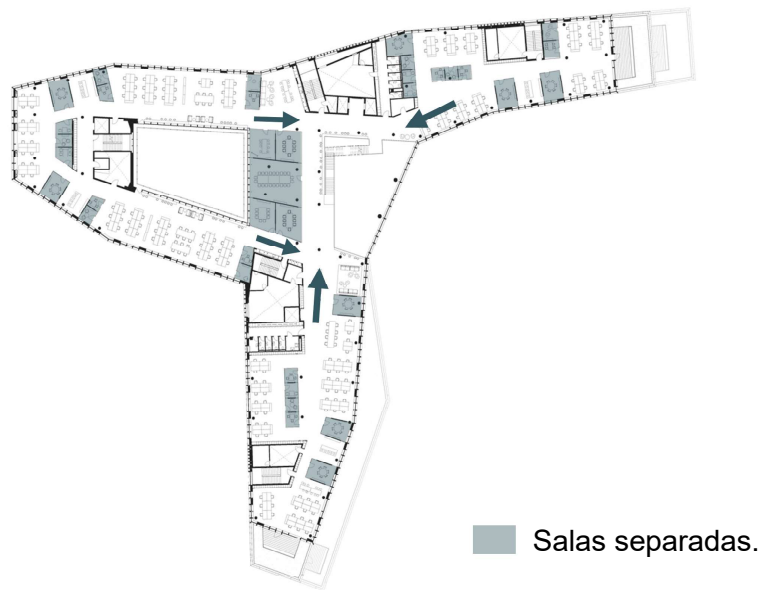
Diagrama del análisis espacial sobre el plano de la primera planta.
